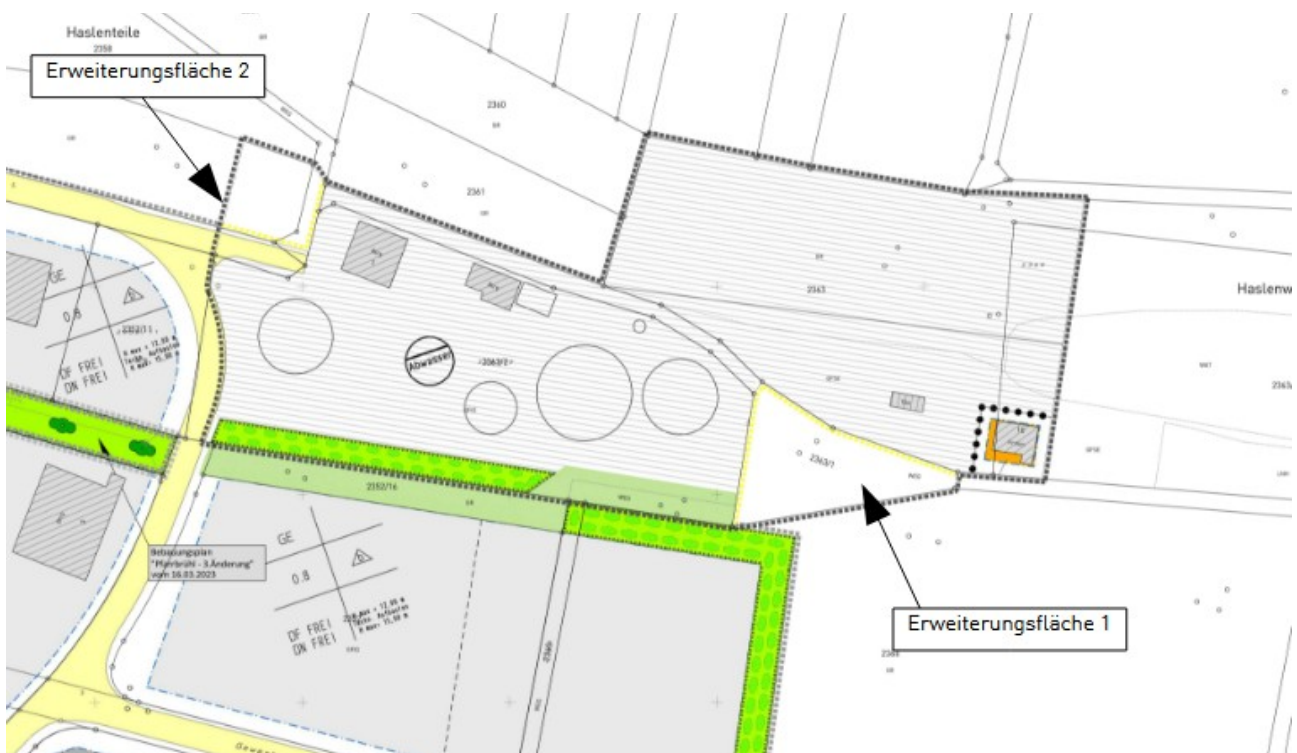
Rechtskräftiger Bebauungsplan „Pfarrbrühl – 2. Änderung“ vom 12.02.2004 mit Darstellung der geplanten Erweiterungsflächen 1 und 2
